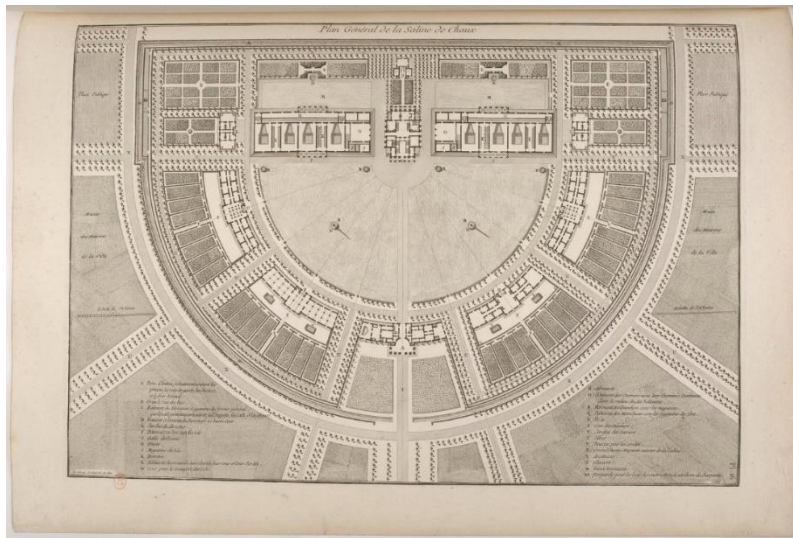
Planta do projeto para as Salinas de Chaux, por Claude Nicolas Ledoux, 1774.
